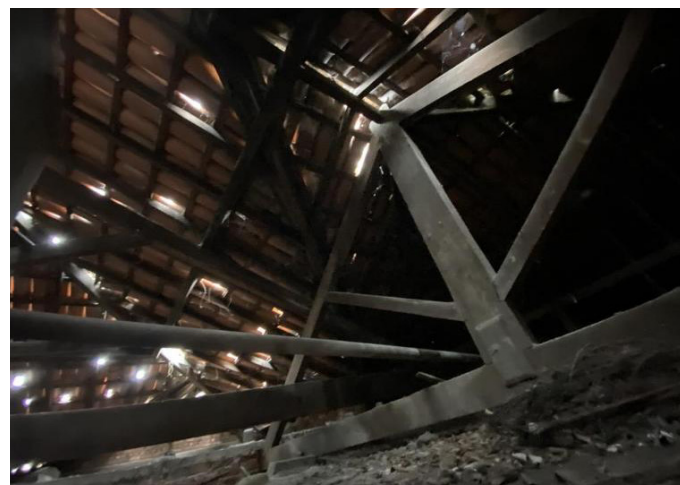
Vista do telhado pela abertura no forro do teto do banheiro.
